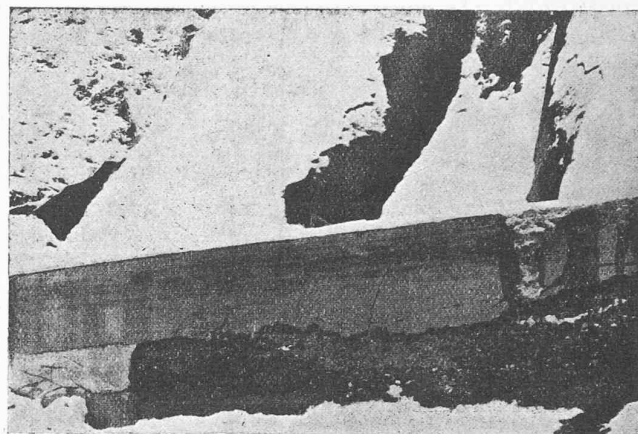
Fissure horizontale au pied des voûtes du secteur de droite.
